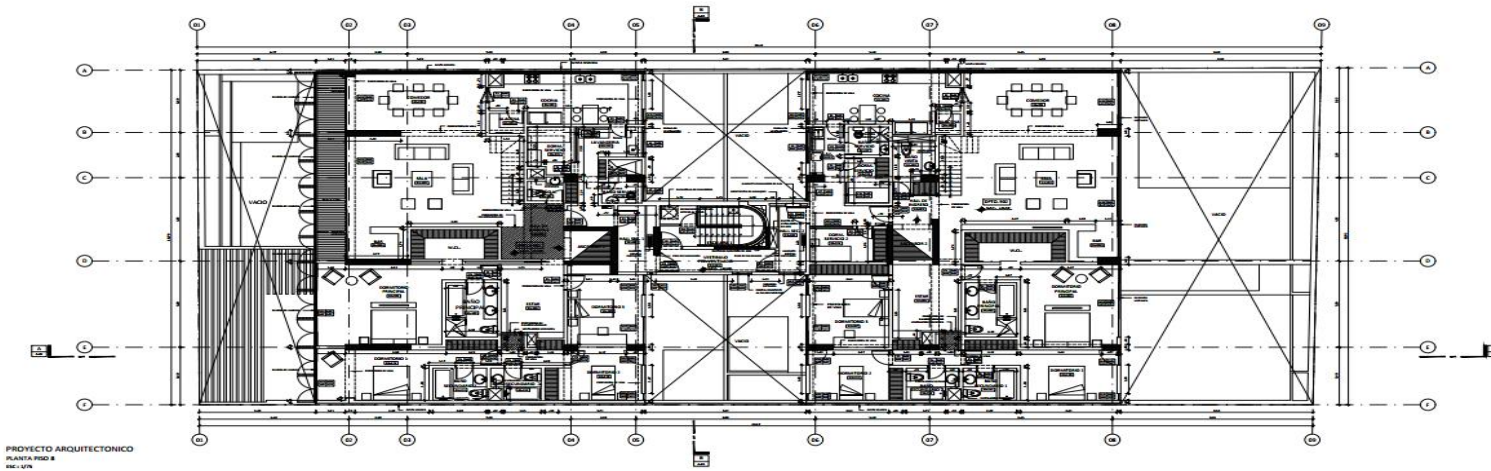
Plano de distribución arquitectónica del 1º nivel
